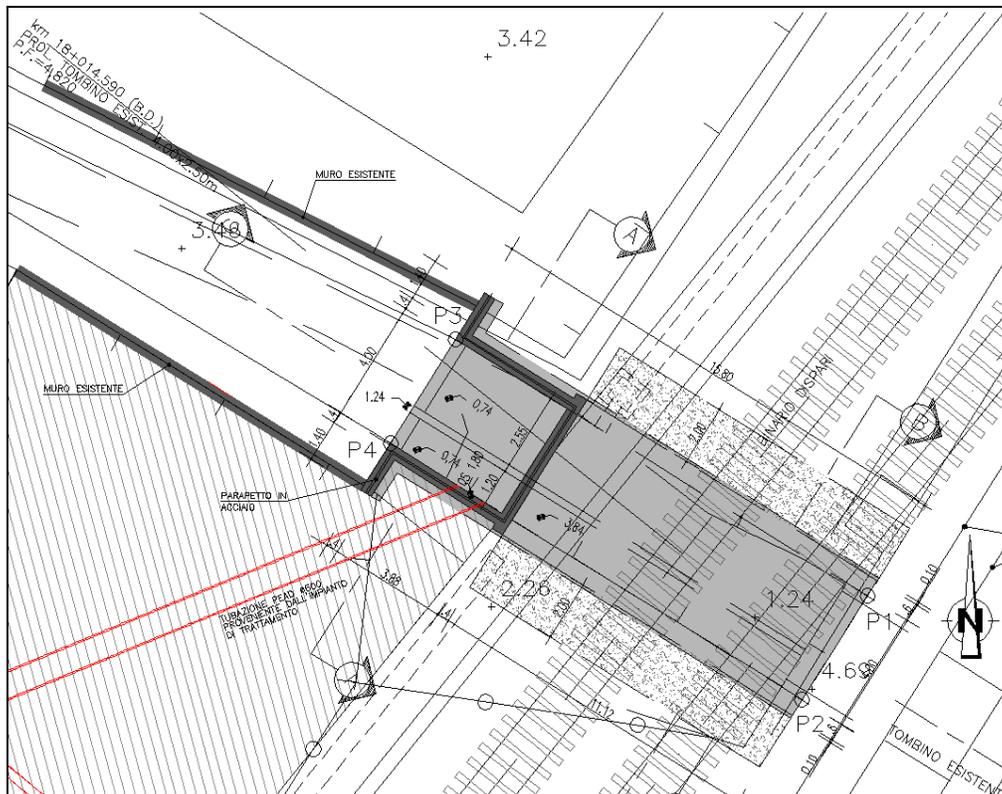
stralcio planimetrico di dettaglio attraversamento idraulico 4.00x2.50
